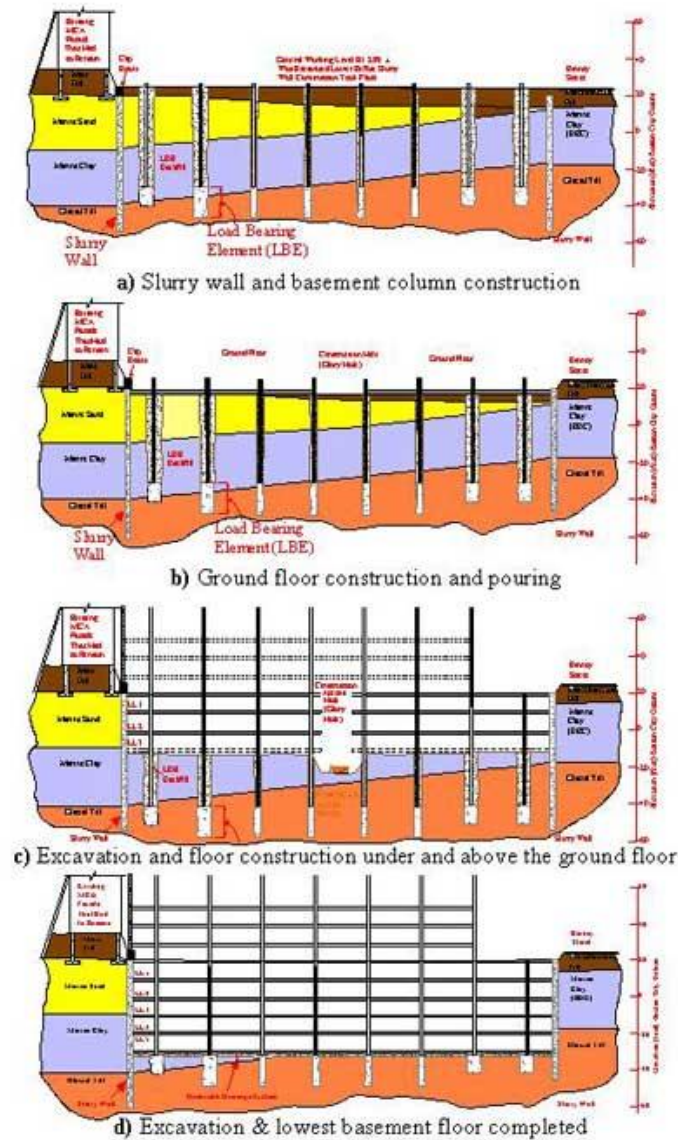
a) Colocación de los muros diafragma y columnas. b) Construcción de la losa de piso c) Excavación y construcción de piso debajo y encima de la losa de planta d) Proyecto terminado (Esquema obtenido de Deep excavation: Reliable geoexpertise.)
